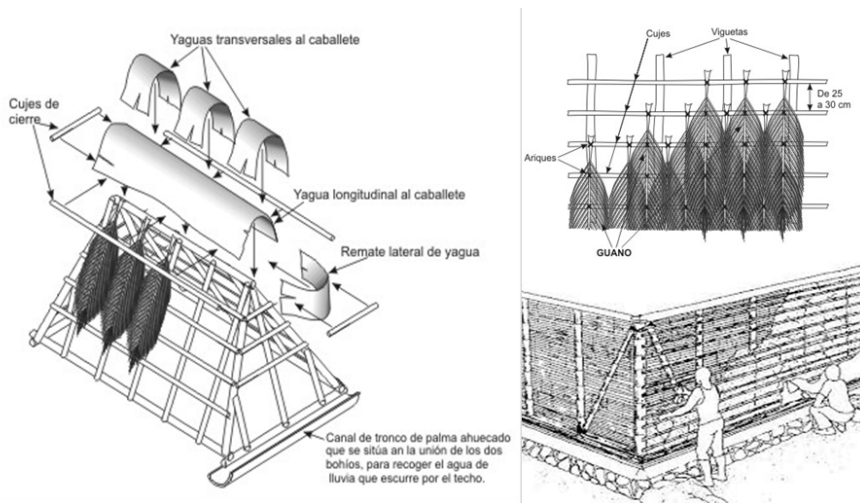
Detalles de Técnicas Constructivas utilizadas con la Palma.
